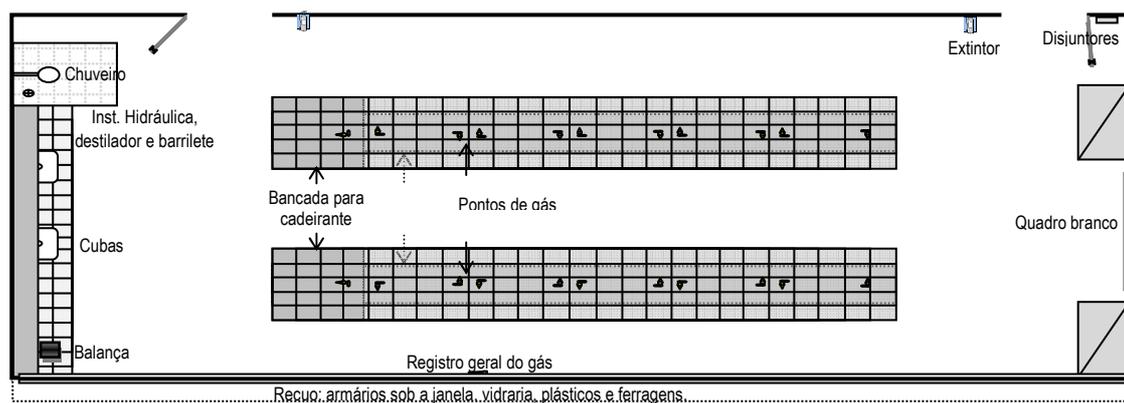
Planta baixa do Laboratório Multidisciplinar do CIEP 432.
